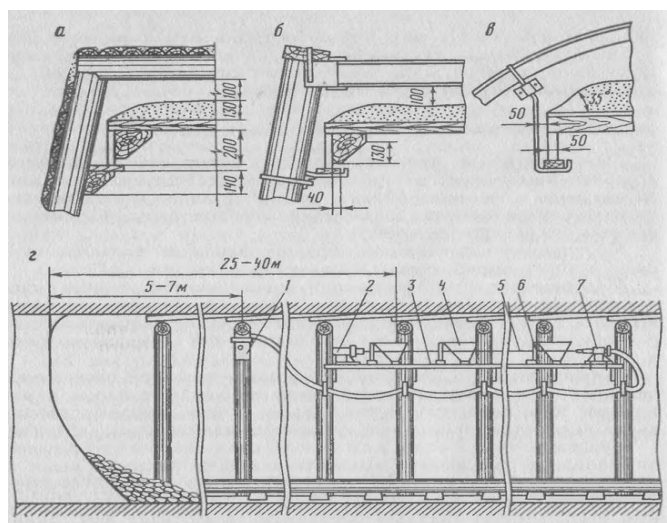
Конструкции сланцевых (а – в) и водяного с принудительным срабатыванием (г) заслонов в выработках с деревянной (а), железобетонной (б) и арочной (в) крепями:
